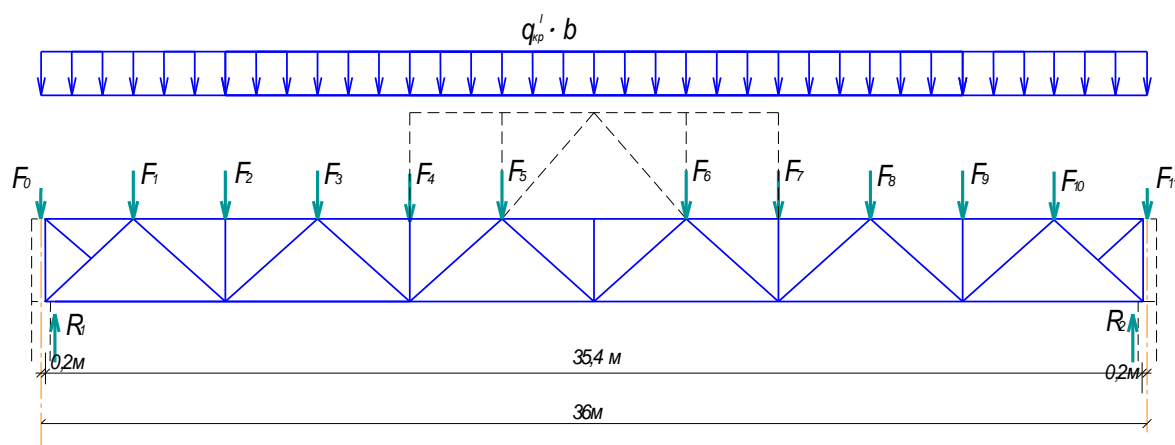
Расчетная схема, сбор нагрузок
